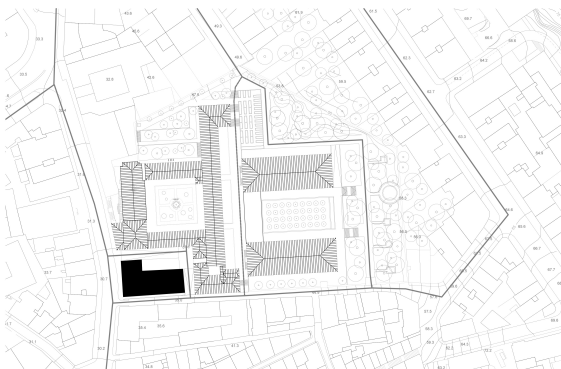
, planta de localização do edifício da administração no complexo HSM, planta esquemática sem escala.
